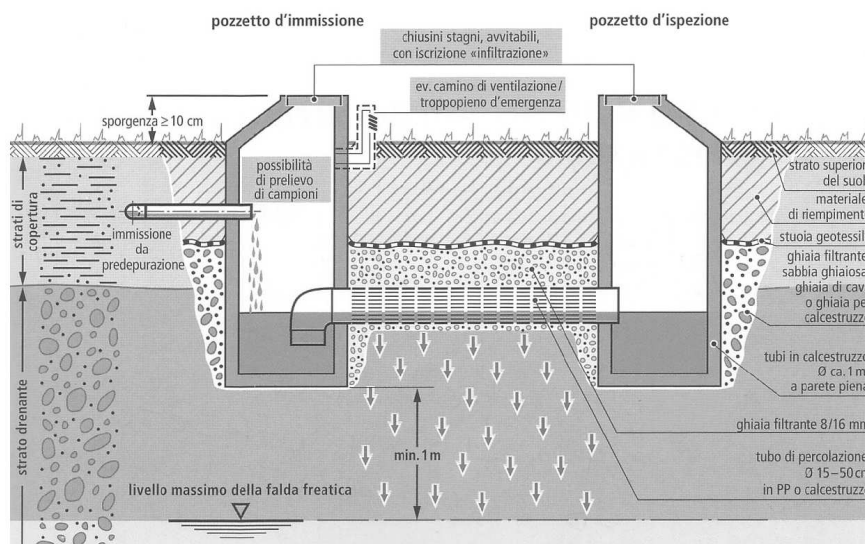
SEZIONE TIPO DI POSA TRINCEA DISPERDENTE
